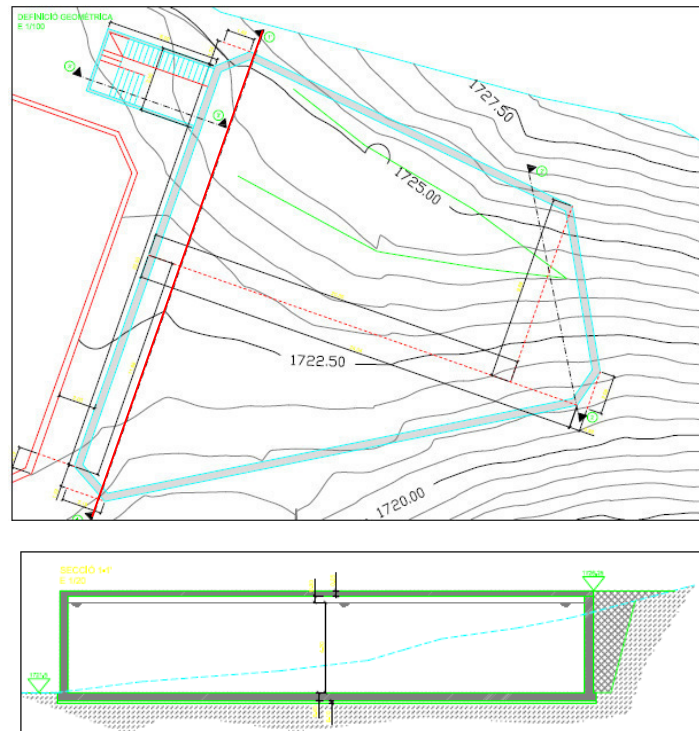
i Figura 2. Plànol en planta i en secció del tall en vermell del nou dipòsit a construir.
